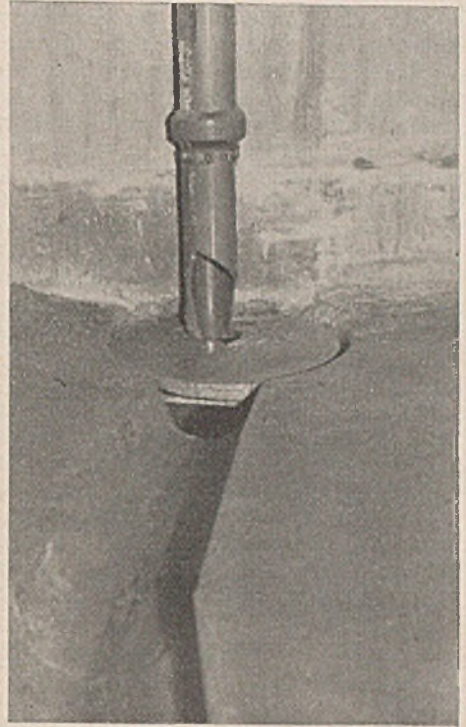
Bauwerk II, Einmündung des Steinzeugfallrohrs in den Betonschacht (über dem Schacht Betondeckel, das Fallrohr ist durch Eis zerstört).
